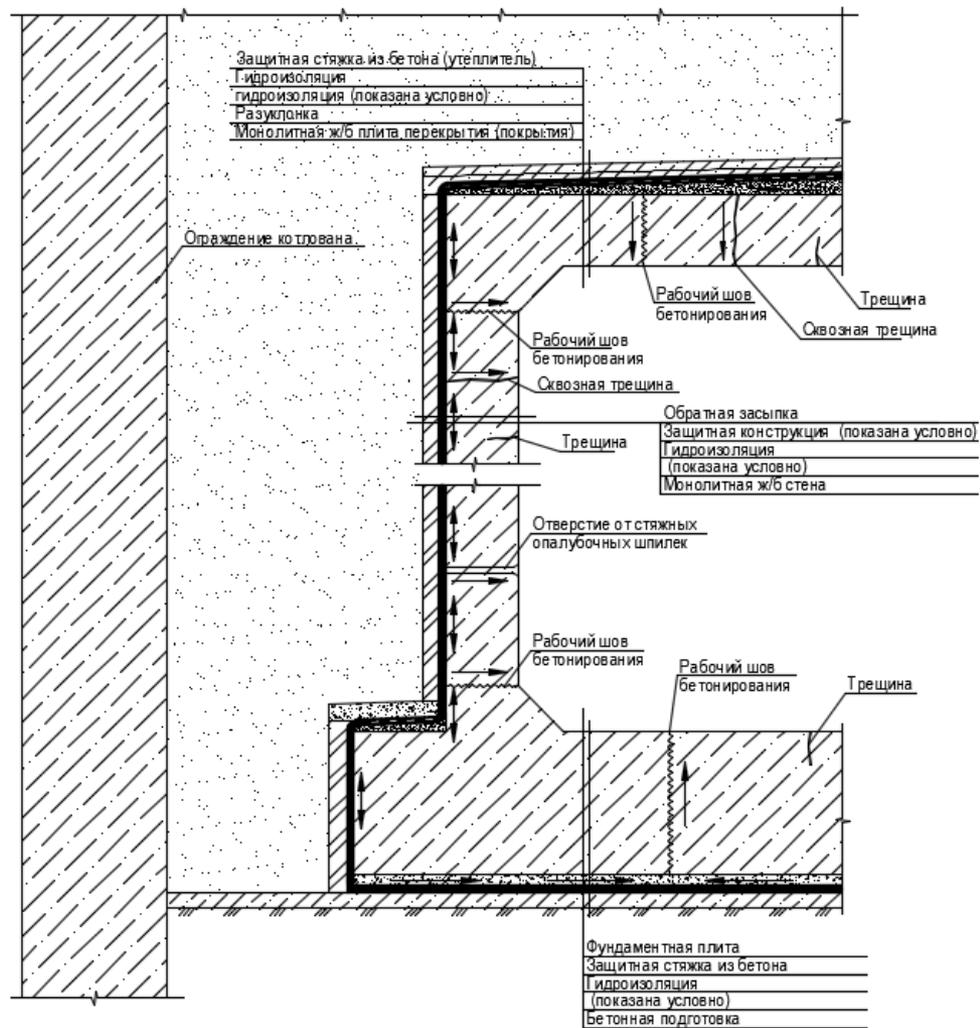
Схема хаотичной миграции воды по контакту между гидроизоляцией и поверхностью бетон конструкций без обеспечения адгезии
